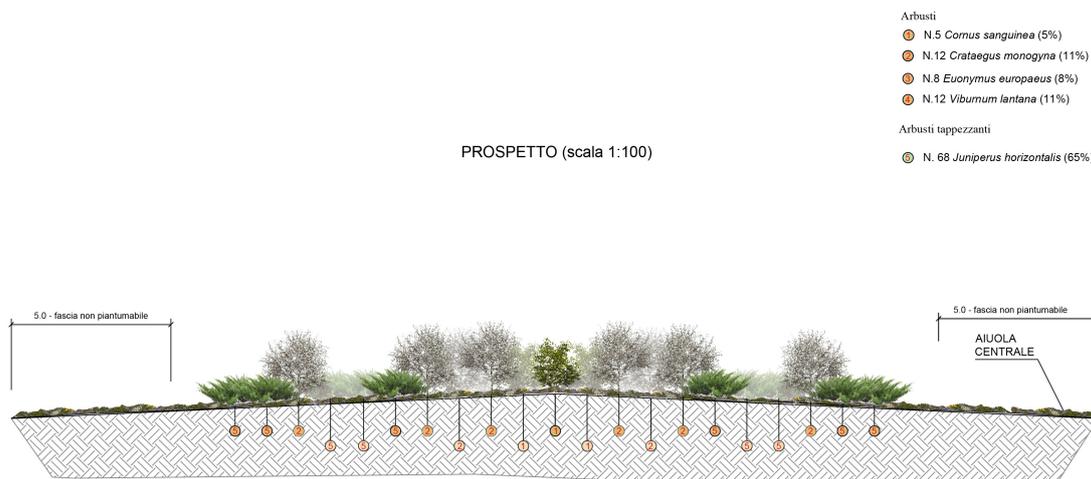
Prospetto piantagione rotatoria modulo PI-RO 1
